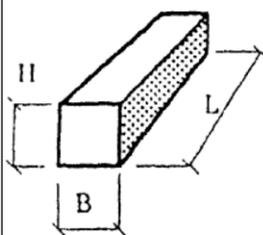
Сборные железобетонные ленточные фундаменты
